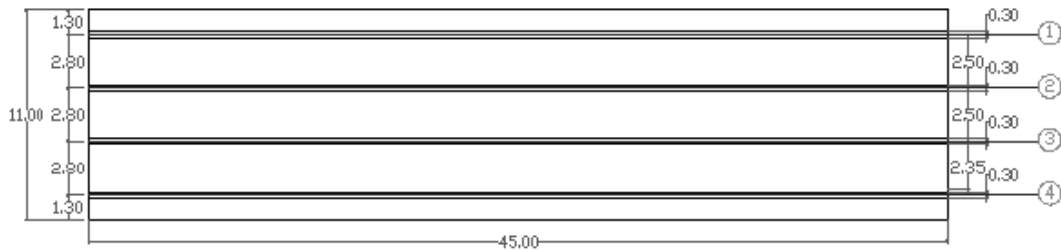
Planta del puente de sección compuesta de vigas longitudinales simplemente apoyadas de acero y tablero de hormigón armado
